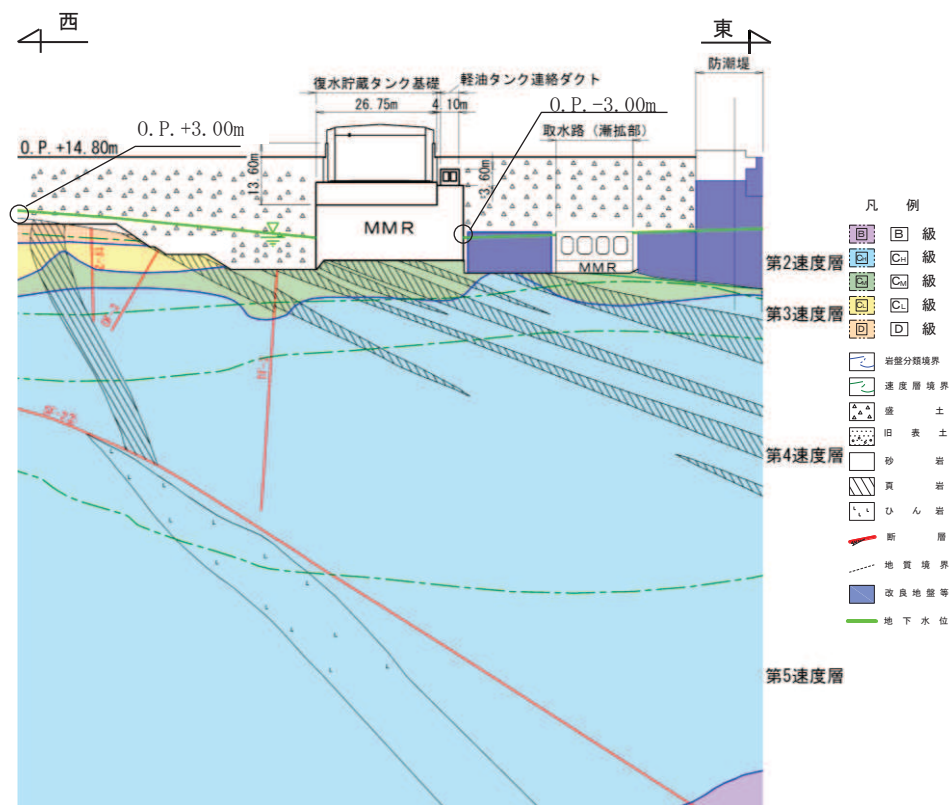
(2) 復水貯蔵タンク基礎 地震時荷重算出用地質断面図 (B-B 断面, 東西)
